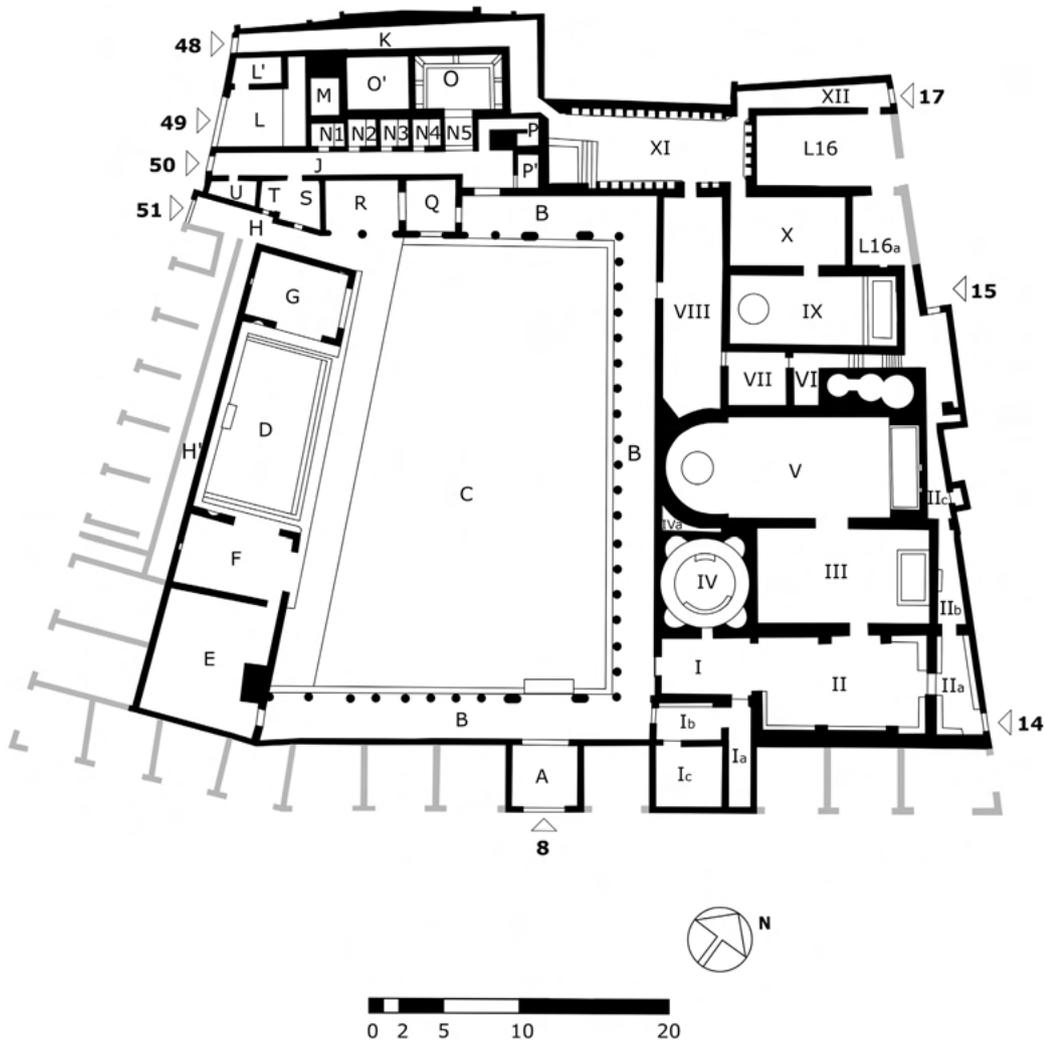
Stabianer Thermen, Grundriss, letzte Phase (nach M. Trümper)
